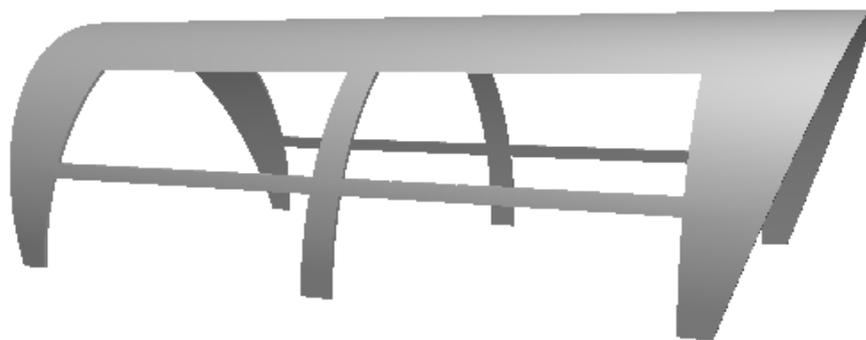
Cobertura em concreto armado moldada *in loco*, pensada inicialmente para o projeto.
